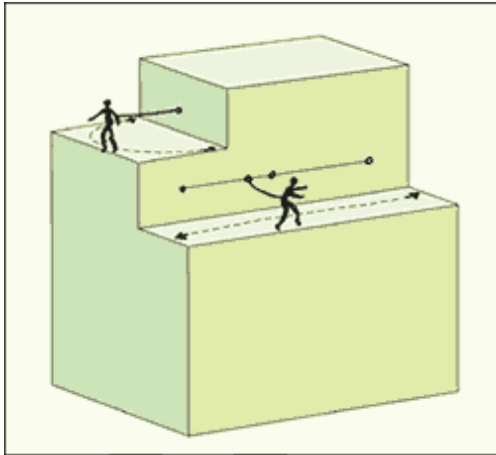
Predisposizione di mancorrente di protezione
